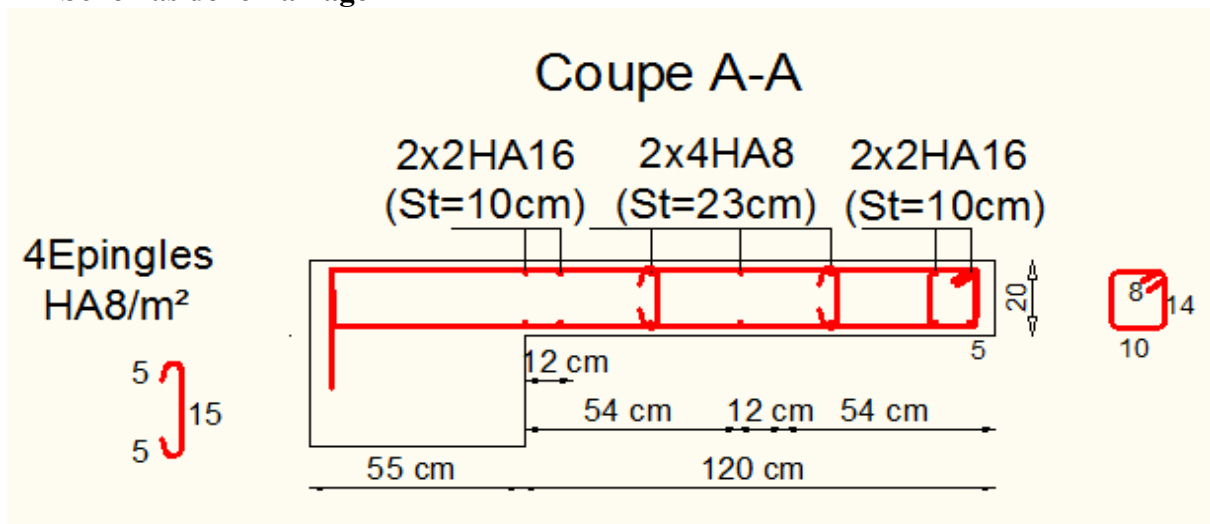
Schéma de ferrailage du Voile  $V_{y2}$  (niveau R.D.C)
